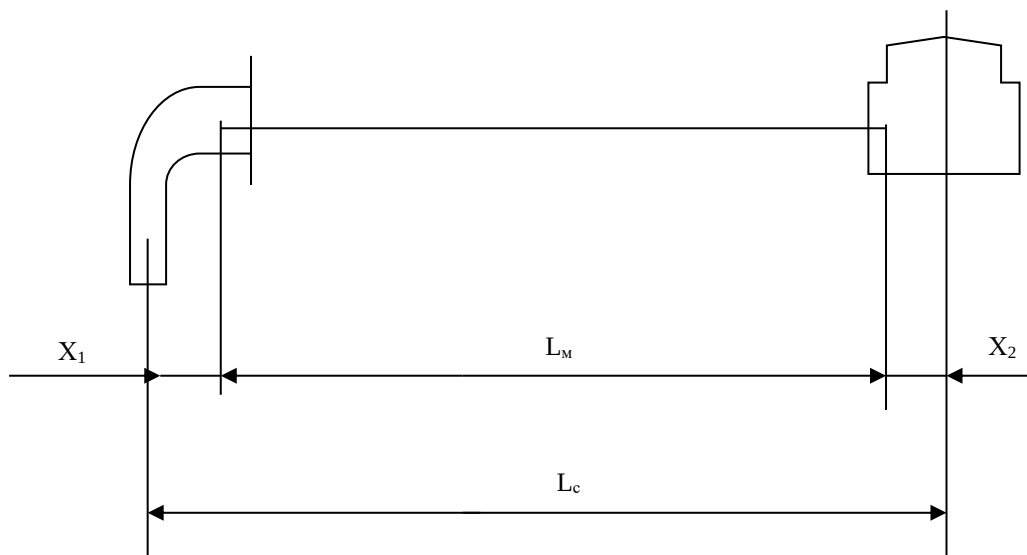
Будівельна (L_c) і монтажна (L_m) довжина виробу:
